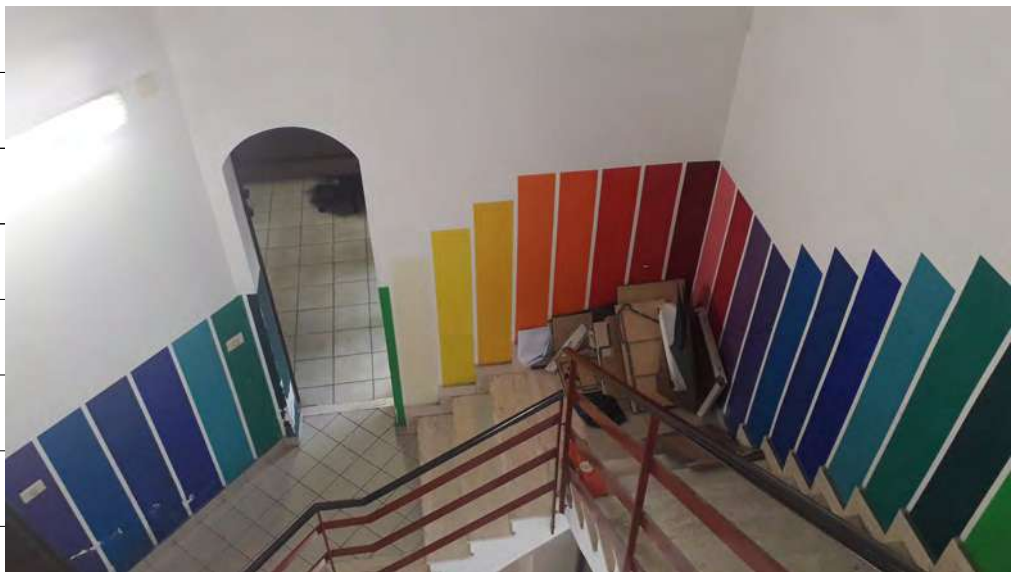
immagine interna del corpo scala di collegamento tra i piani terra, primo e secondo.
